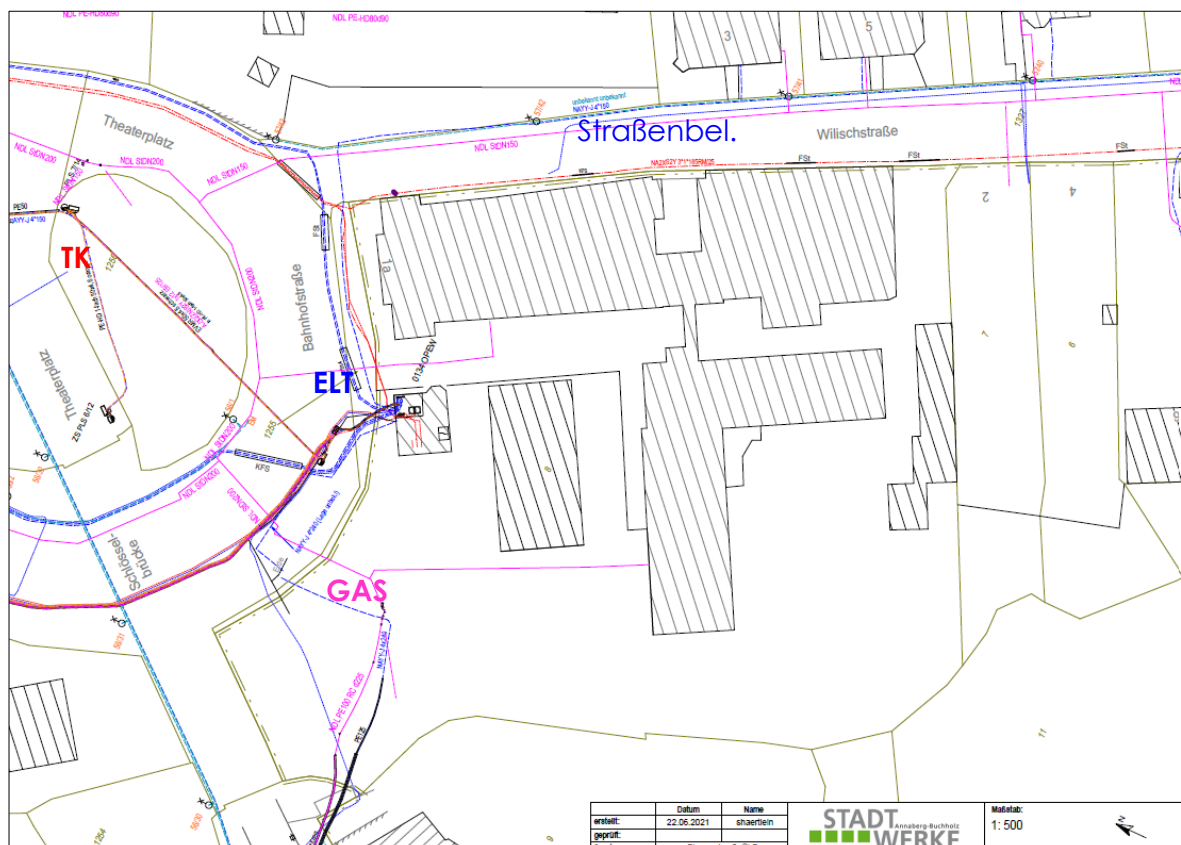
Leitungsbestand SWA-B im Übersichtslageplan vom Juli 2021
